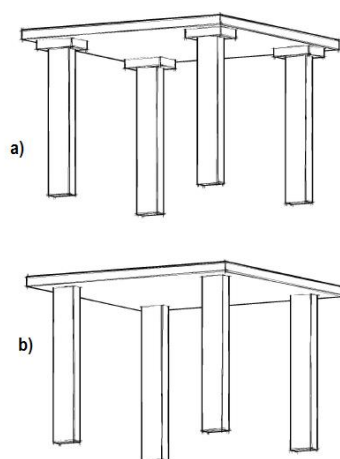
a) Desenho esquemático de uma laje cogumelo; b) Desenho esquemático de uma laje lisa
